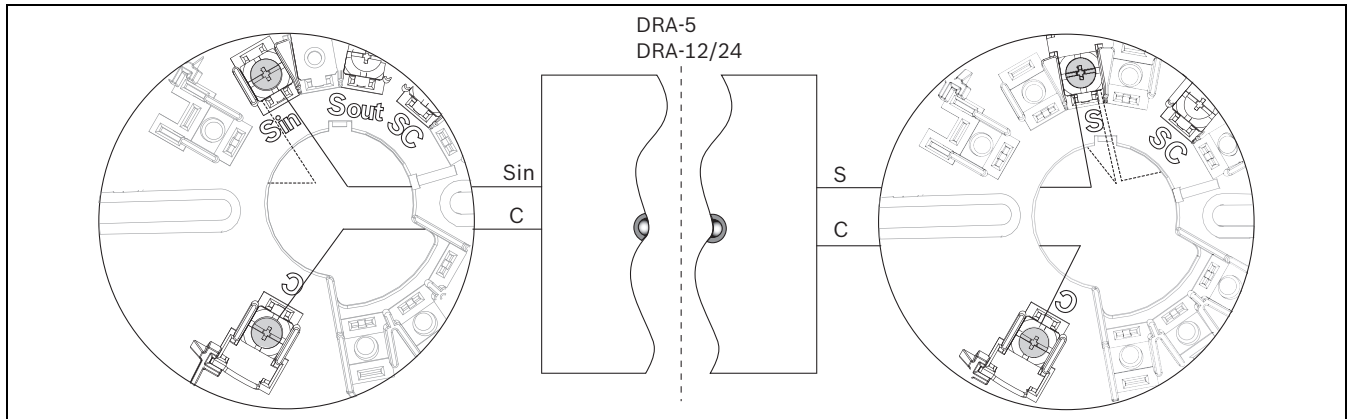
Cableado del anunciador remoto opcional, base aisladora (izquierda) y base estándar (derecha); Sin y S = cable rojo, C = cable blanco
